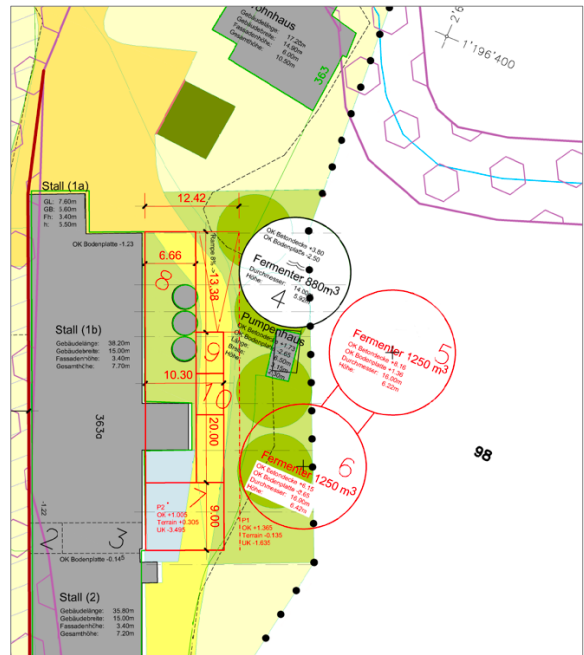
Ausschnitt Projektplan mit heutiger Situation (links) und Erweiterung der Biogasanlage (rechts, rote Kreise)
